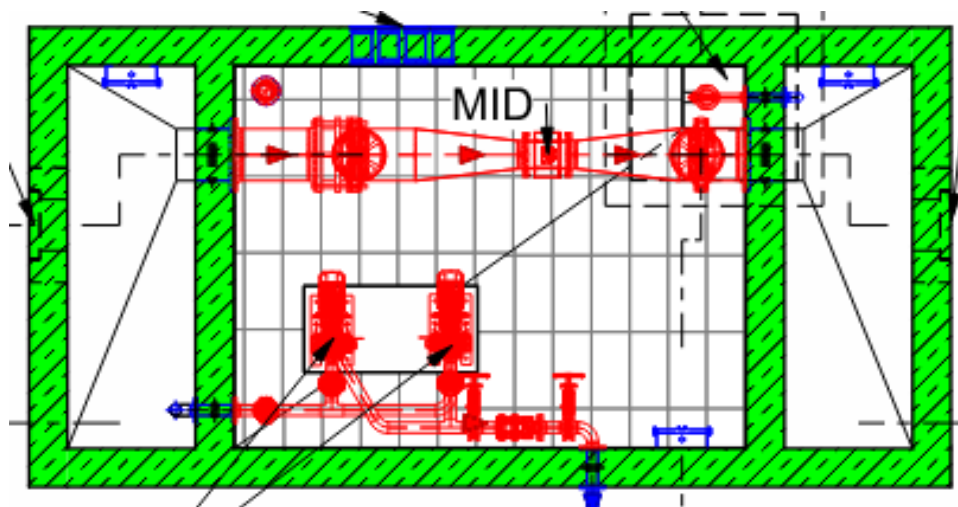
Grundriss Ablaufmessung mit Brauchwasserpumpwerk
